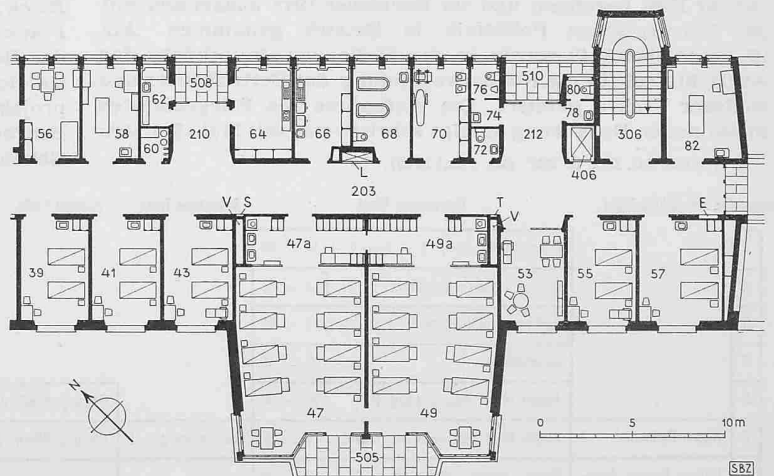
Typischer Grundriss einer Pflegeeinheit im Bettenhaus Ost I, Masstab 1 : 400
